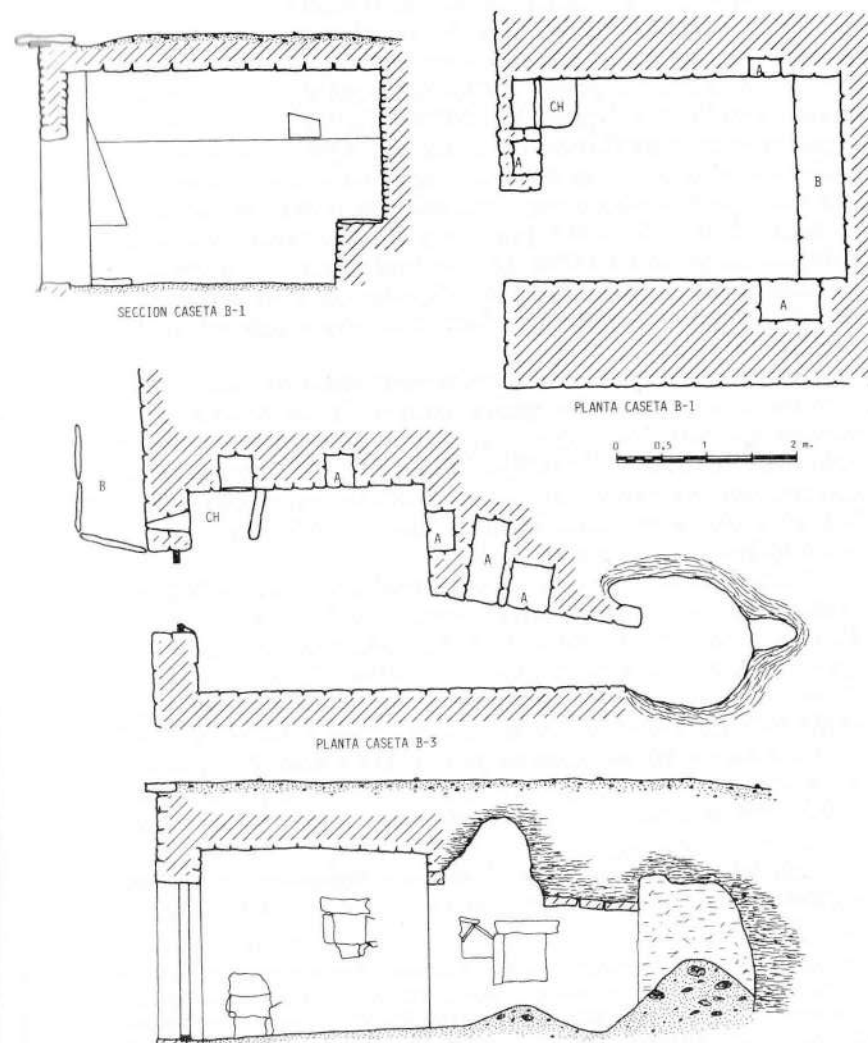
Planta y sección de las casetas abovedadas B-1 y B-3. Abreviaturas: «A» alacena, «B» banco y «CH» chimenea.
